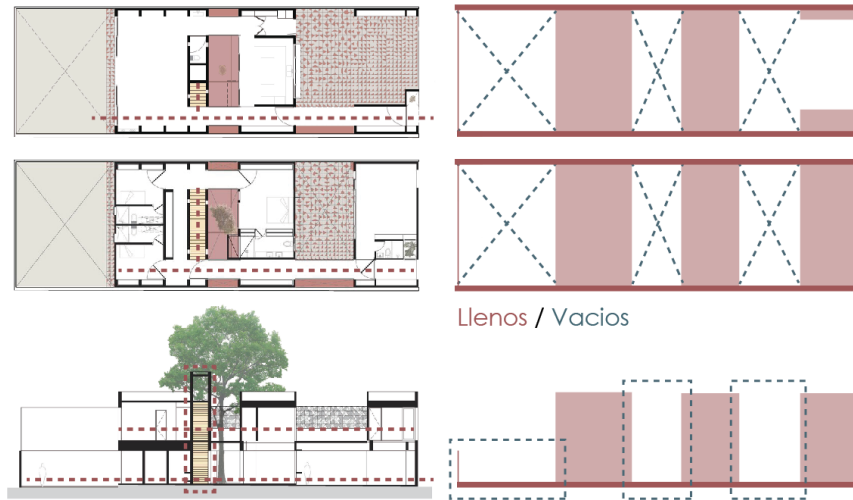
Planta de Cubiertas y Corte Casa Santa Catarina
